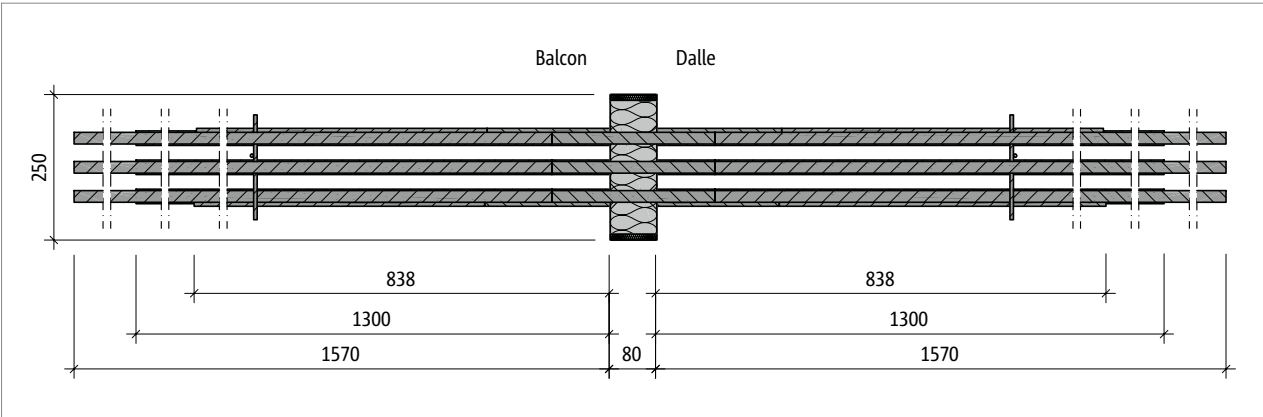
Schöck Isokorb® T Type B-M5-V2 : Plan de base du produit
